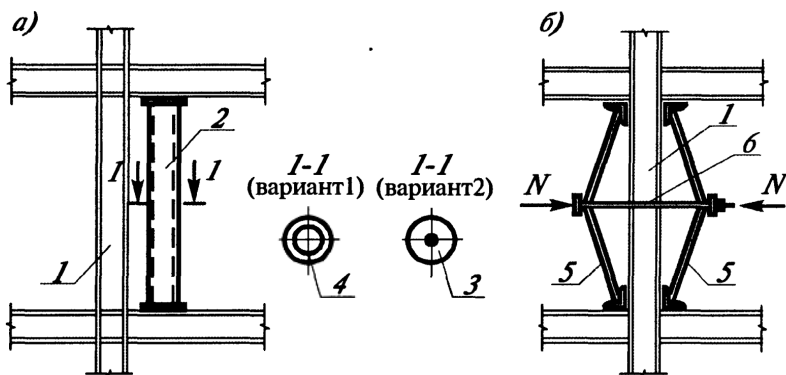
Усиление путем разгрузки сжатых колонн:
